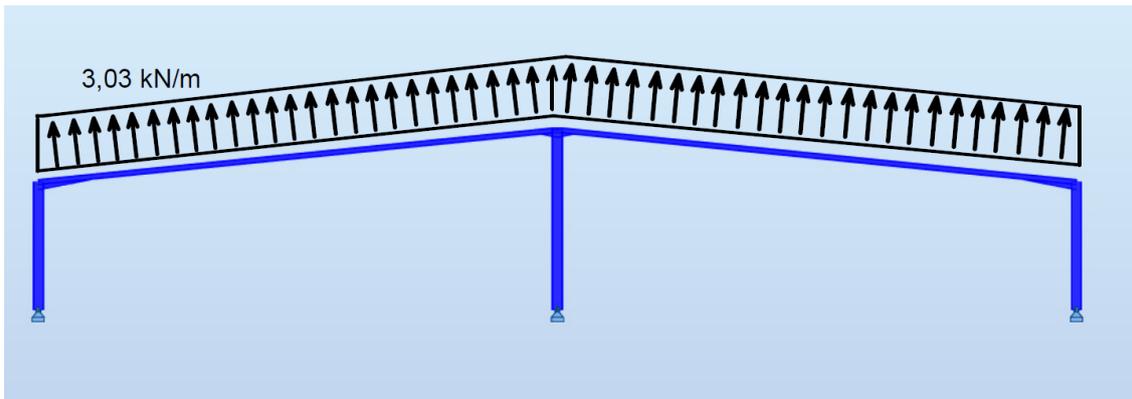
REPRESENTACIÓN PÓRTICO INTERIOR EN ZONA I PARA CARGAS CON DIRECCIÓN LONGITUDINAL A LA CUBIERTA
